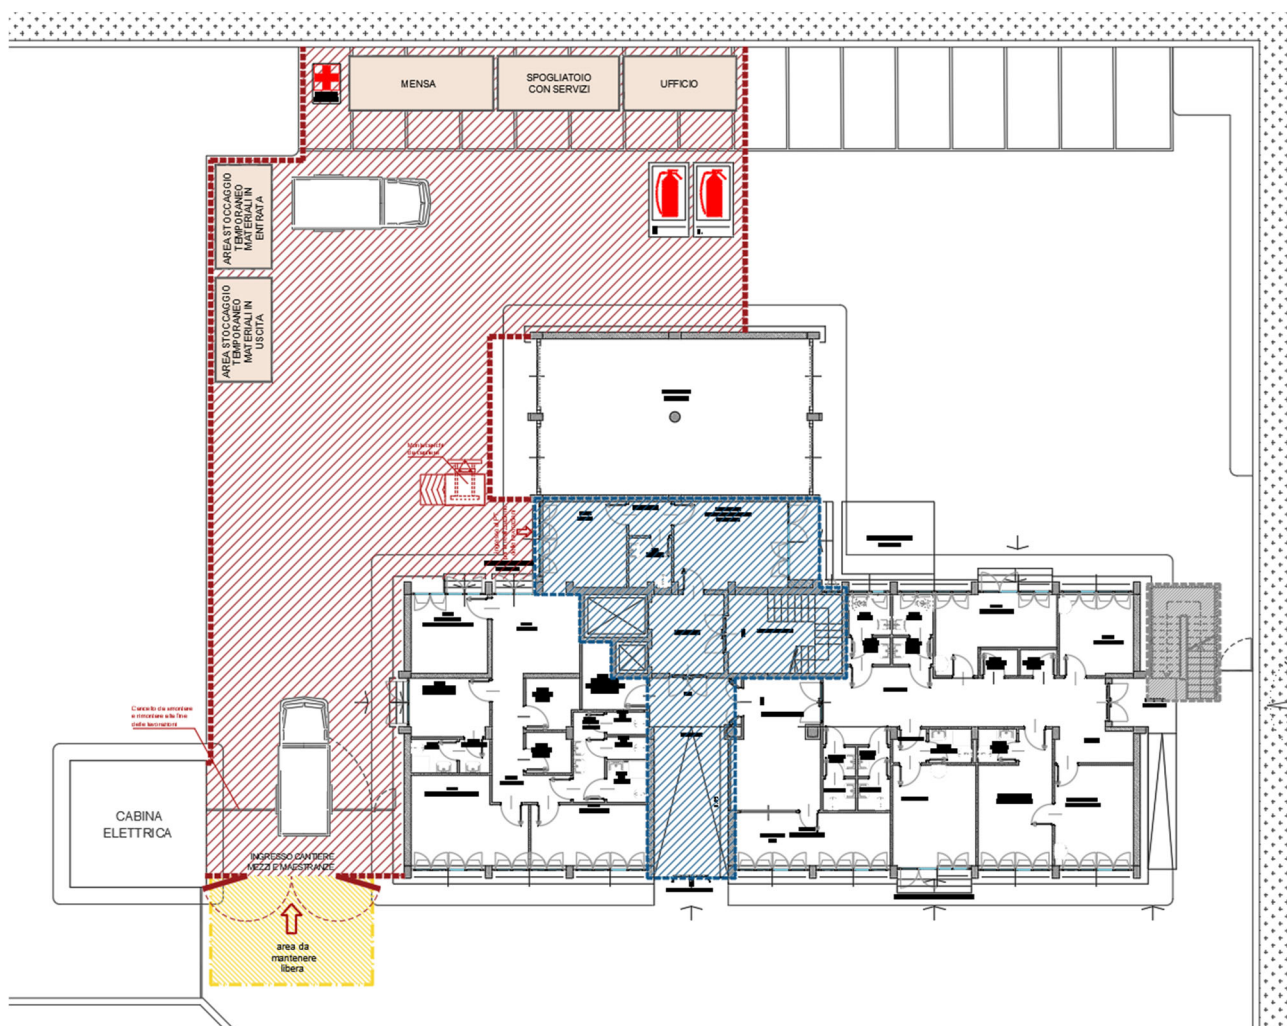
Planimetria del piano terreno con individuazione delle aree di cantiere – Fase 3
